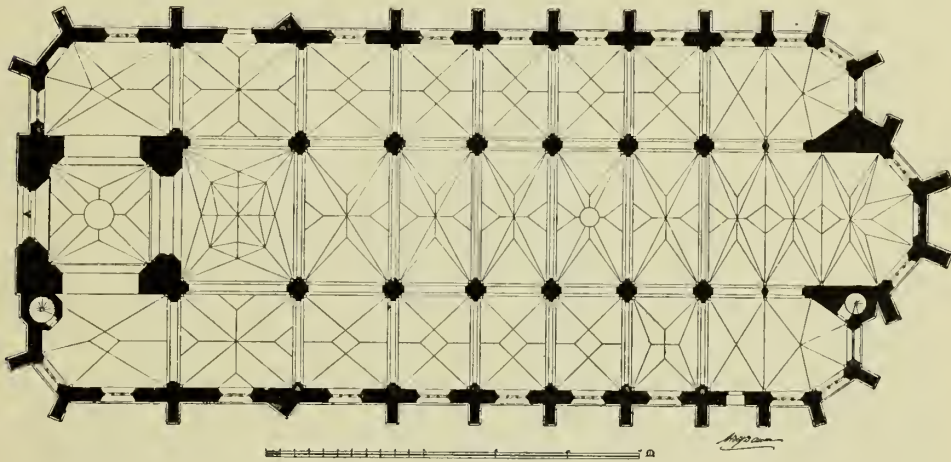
Emmerich Grundriss der Aldegundiskirche.
